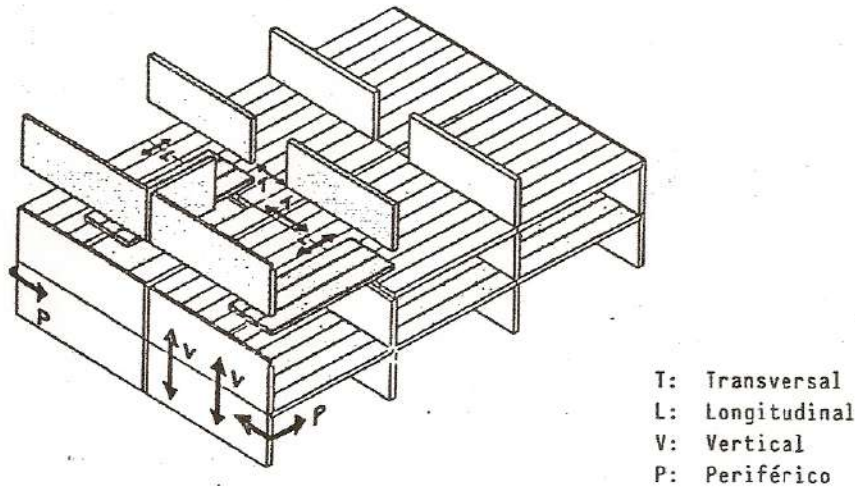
Localización esquemática de los amarres de tracción de estructuras sobre muros
